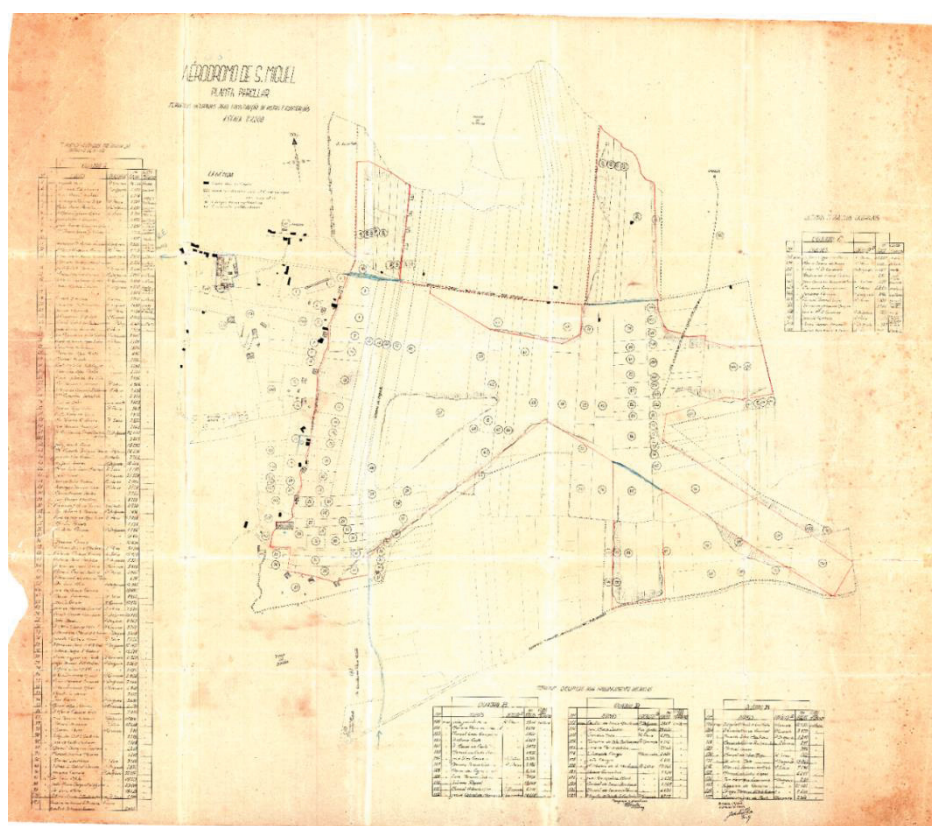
Planta parcelar – Terrenos ocupados para construção das pistas e edificações
